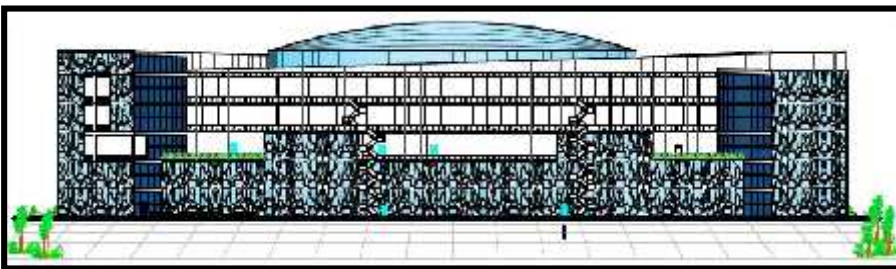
la résille dans la façade est et ouest de centre thalassothérapie
